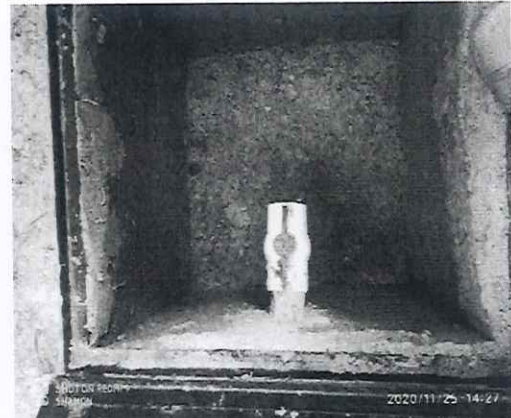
Vista del fondo de caja de registro de lodos donde no existe losa de concreto
